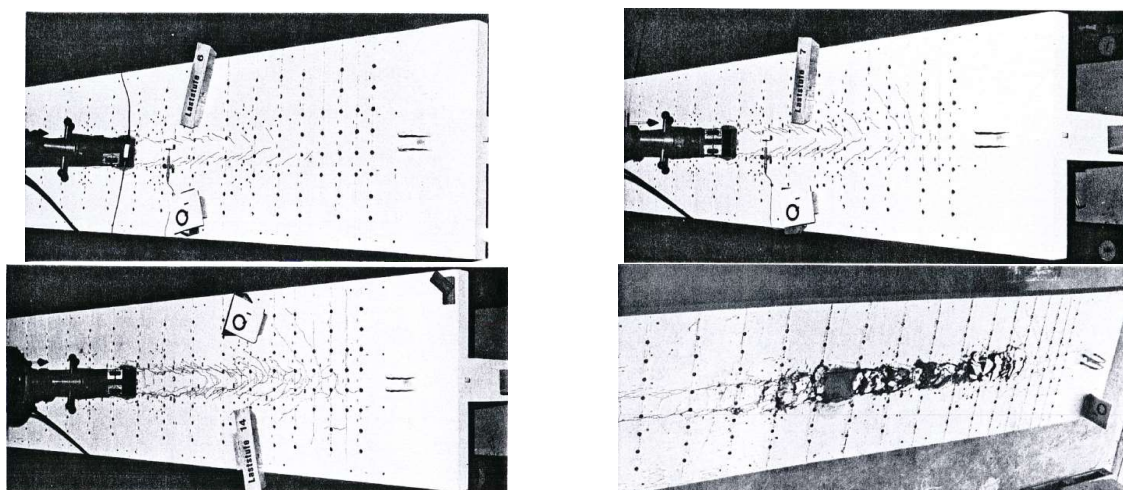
Profil de fissuration d'une des poutres testées sans flexion transversale par (Badawy et Bachmann, 1977)
